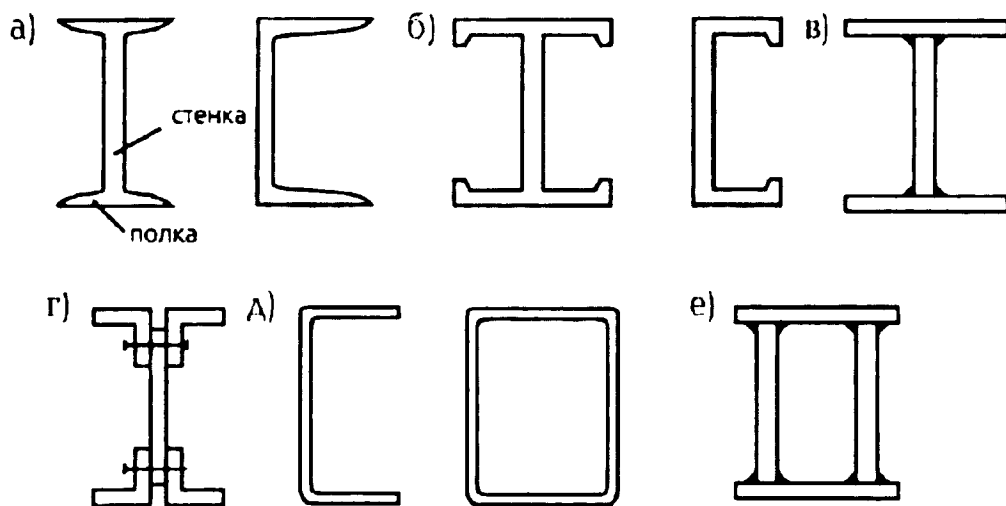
Сечения балок: а - прокатных (двутавр, швеллер); б - прессованных (двутавр, швеллер); в - составных (сварных); г - составных (клепанных); д - гнутых; е - составных (коробчатого сечения)
